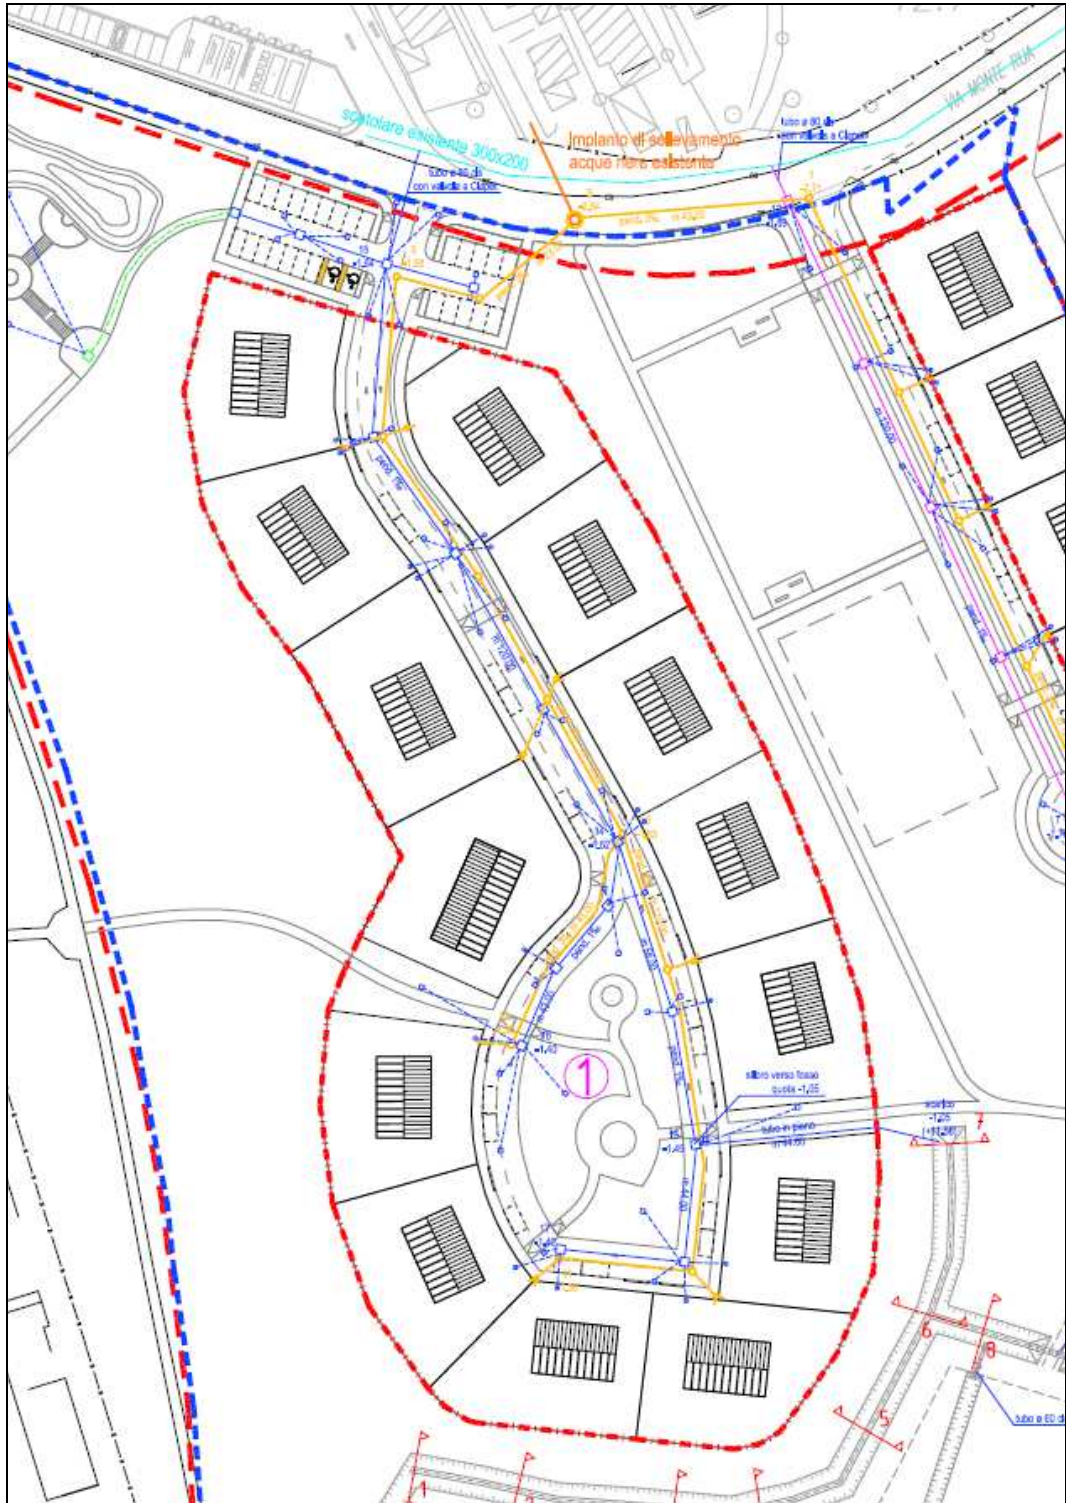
Planimetria della nuova rete di raccolta ed invaso delle acque di pioggia porzione meno estesa del Piano di Lottizzazione Brentella.
